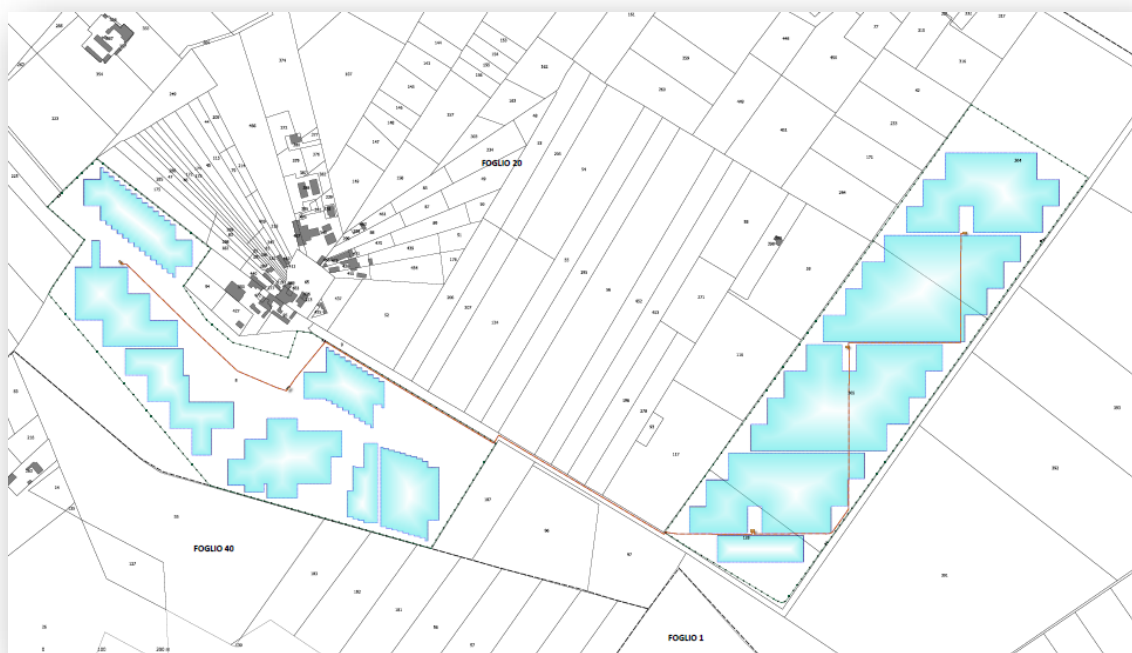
Estratto elaborato A.12.a.16.a_Planimetria catastale aree oggetto di intervento
